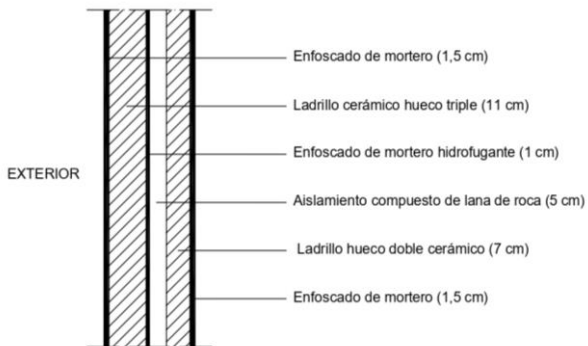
Detalle composición de Fachada. Fuente propia 2024
